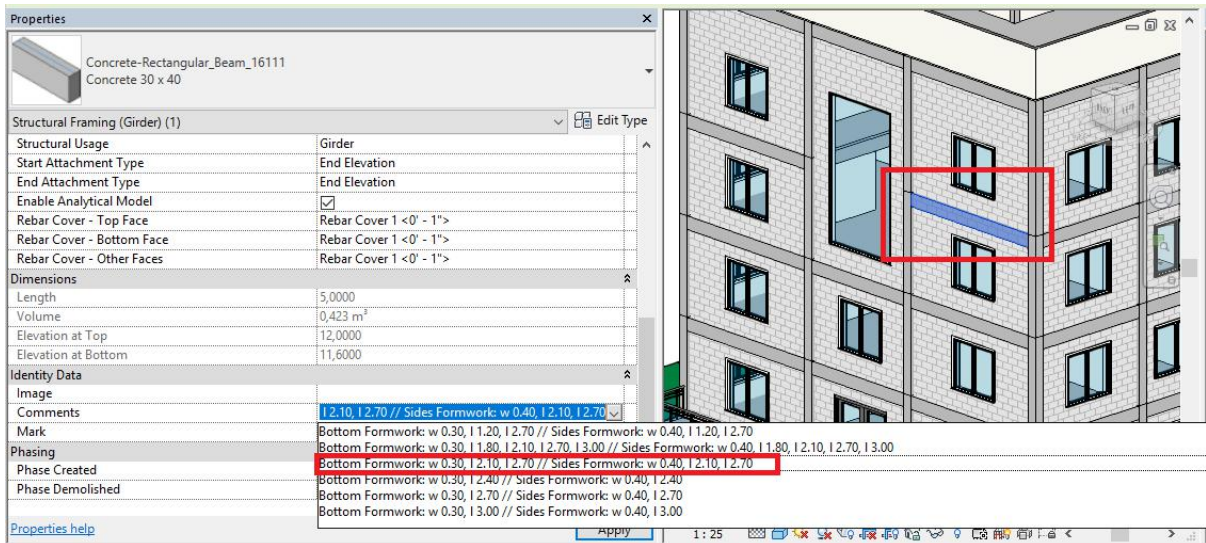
Formato visual de entrega de resultados para una viga de concreto reforzado en el modelo piloto
